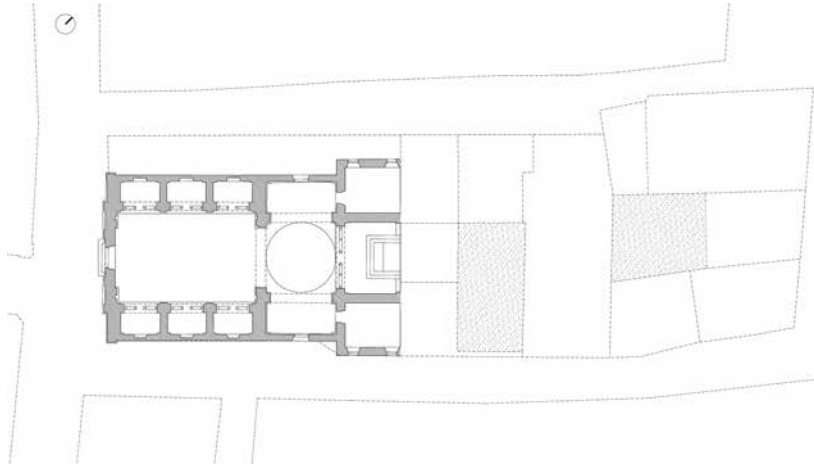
Ricostruzione planimetrica isolato. Inserimento pianta Chiesa di San Pietro 1600. Elaborazione grafica arch. Valentina Radi
